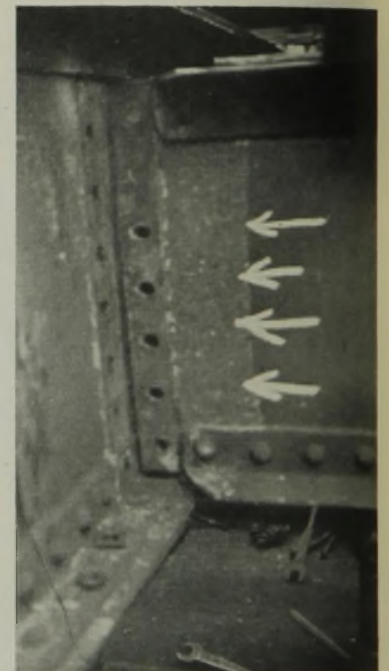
Stehblech eines Längsträgers mit eingefressenen Nietlöchern.
